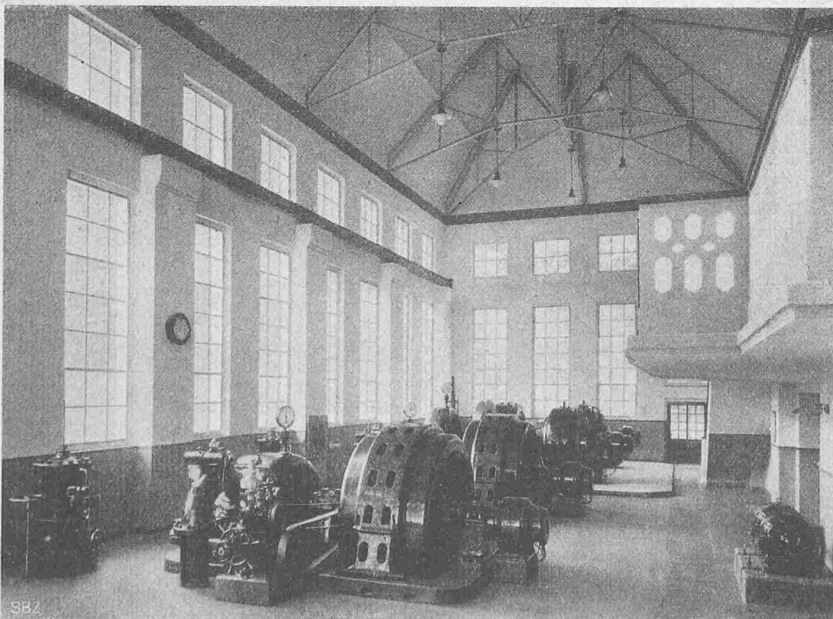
Innenansicht des Maschinenhauses bei Lüen.
